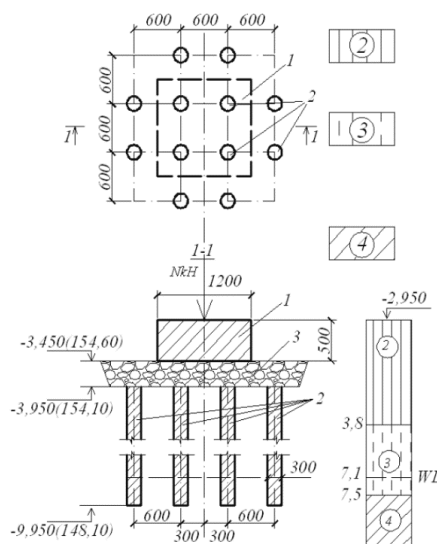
Схема випробувань основи, з армуванням вертикальними ґрунтоцементними палями та квадратним залізобетонним штампом
